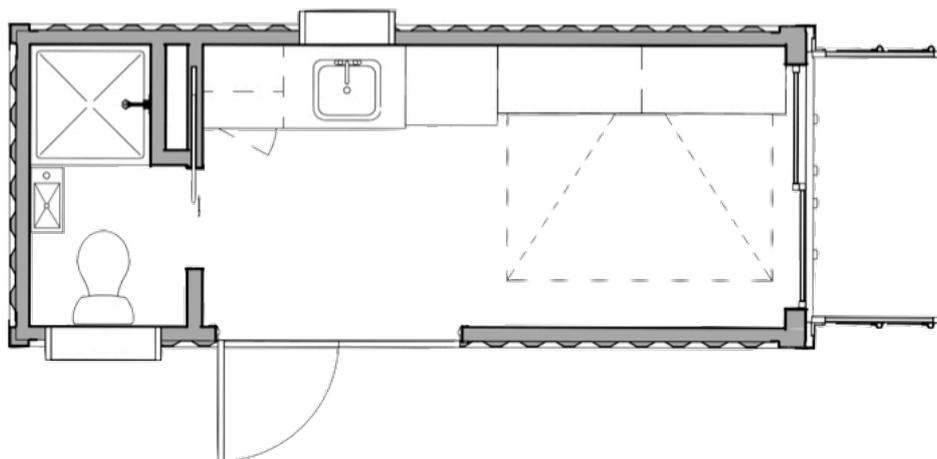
Planta baixa (RHINO CUBED, 201?).
